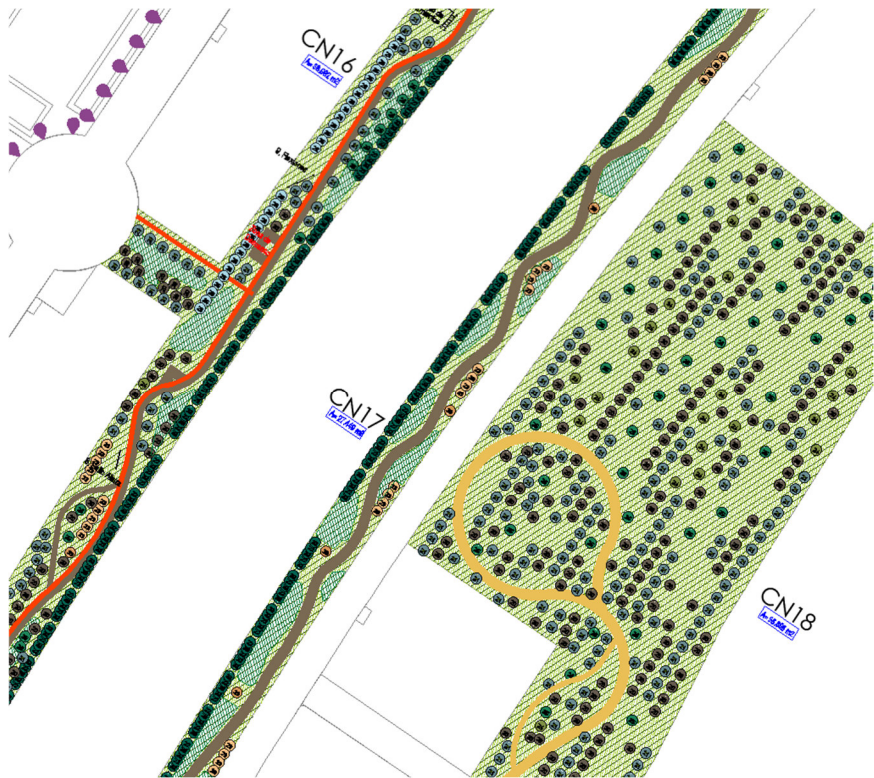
Zoom detallado de plantaciones previstas en zona central corono noreste-sureste.
